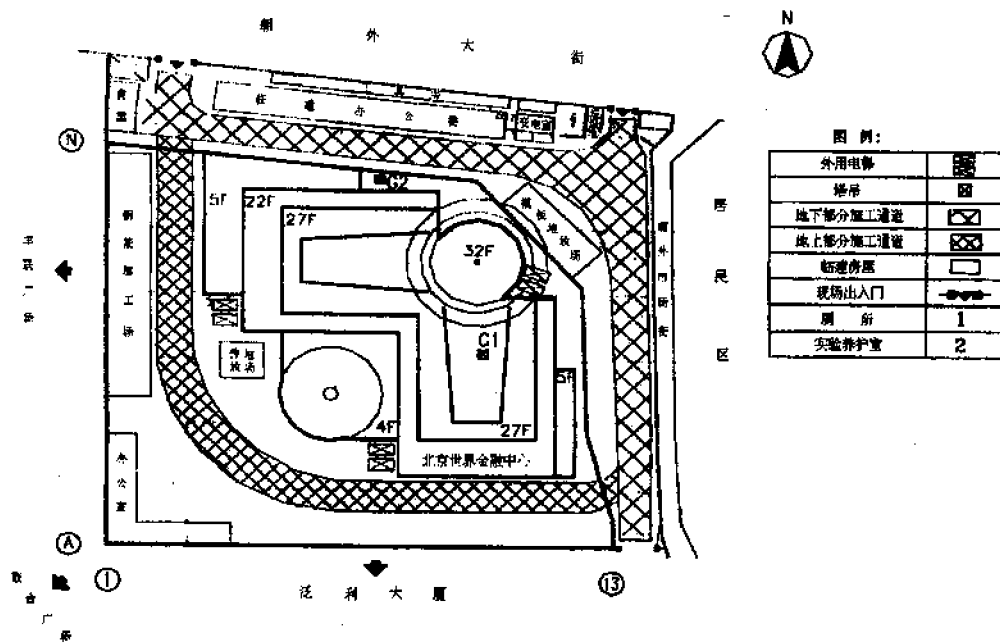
(13) 地上结构施工阶段平面布置示意图
